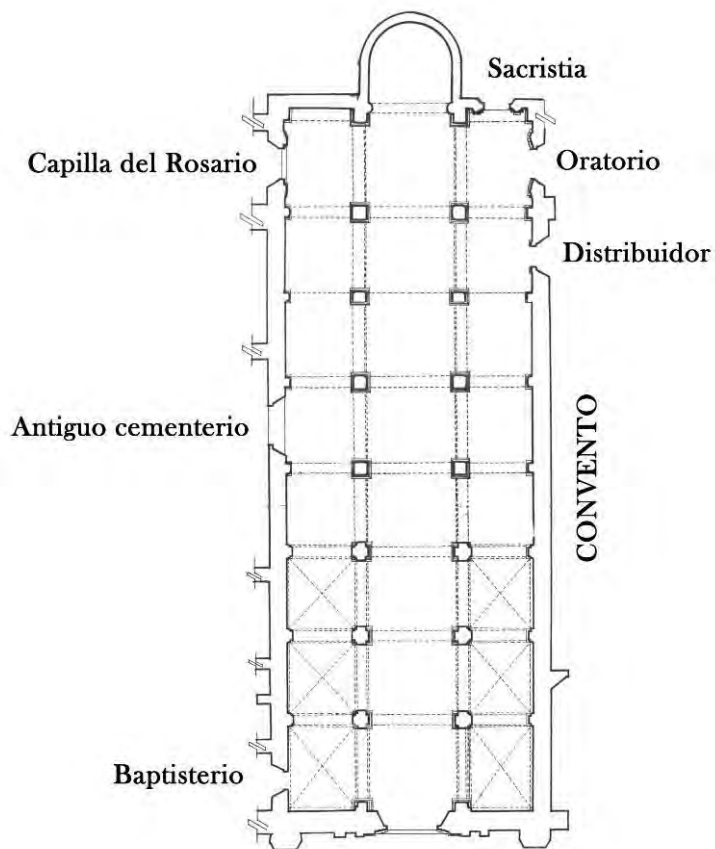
Templo de San Juan Bautista, 1923,⁵⁵⁶ planta baja. El plano que se muestra fue realizado para los trabajos de remodelación efectuados en 1975, se basaron en la planta de mayo de 1923.
